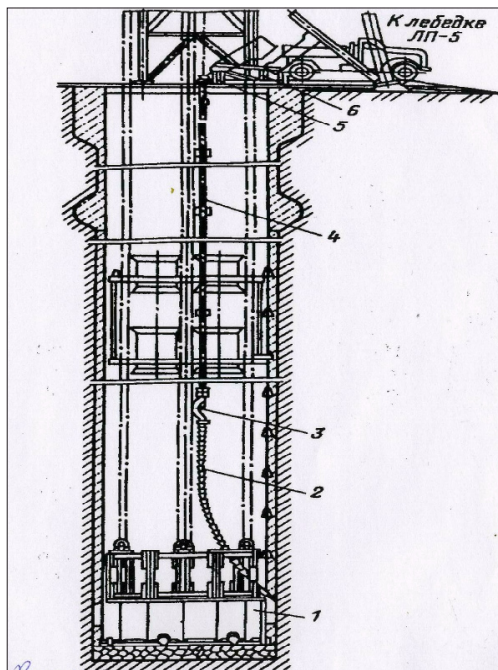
Схема размещения оборудования для возведения бетонной крепи:
